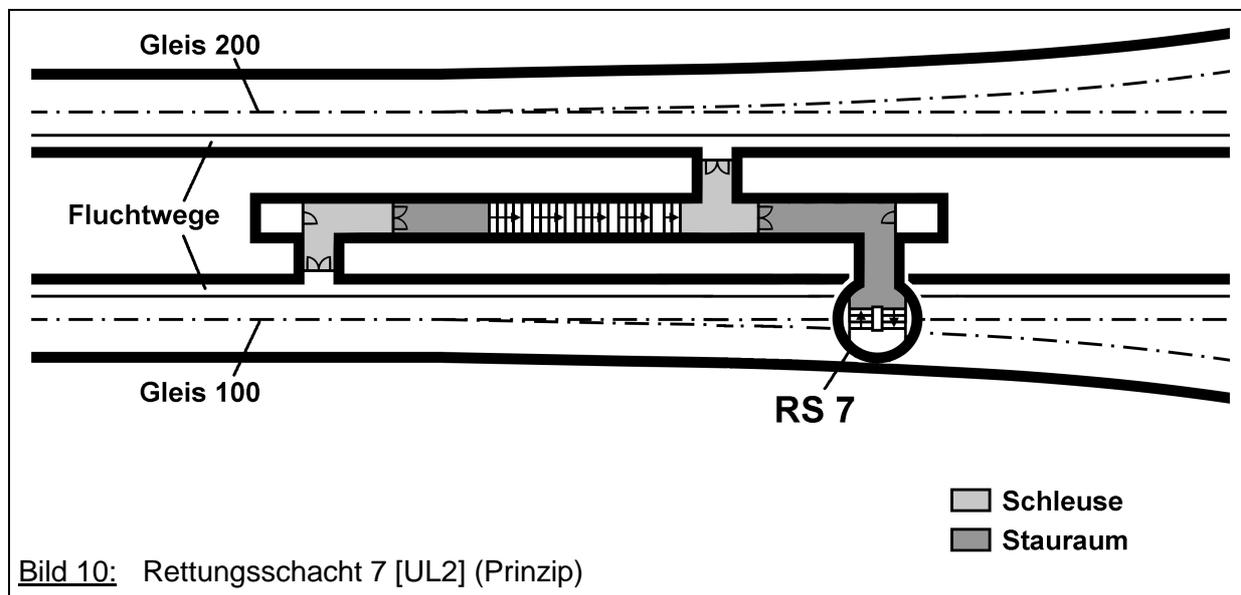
Rettungsschacht 7 [UL2] (Prinzip)
